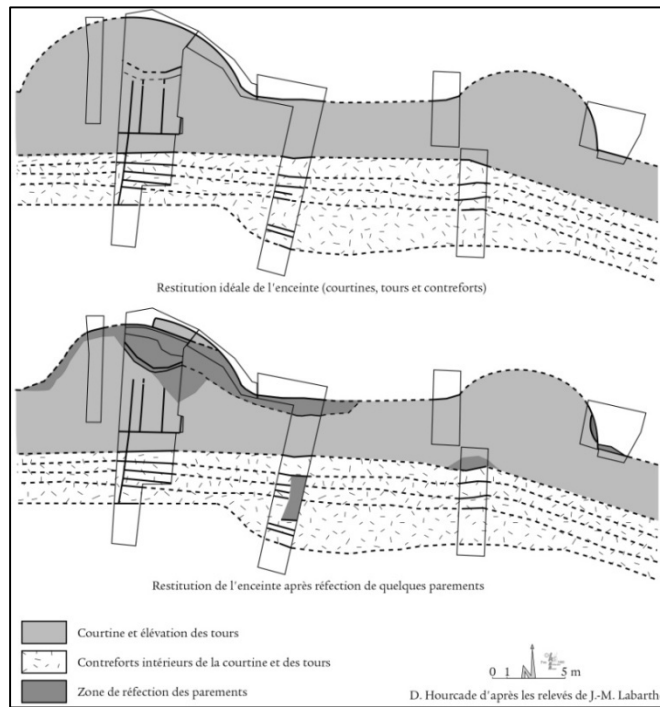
Planimetría del tramo de muralla documentado sobre el Cerro de Benfica en Mértola, fechado en torno al siglo III-II a.C., donde se pueden observar las torres de planta semicircular y los contrafuertes interiores a ellas adosadas (Hourcade, Lopes y Labarthe, 2013).
